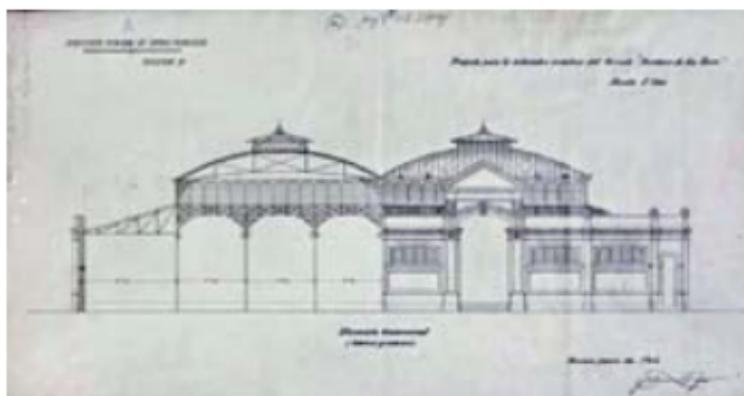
Mercado Martínez de la Torre, proyecto para la techumbre metálica, 1905. Planta AHDF, Planoteca; Planero 2; Módulo 3; Fajilla 52. Foto: RV, 2012
